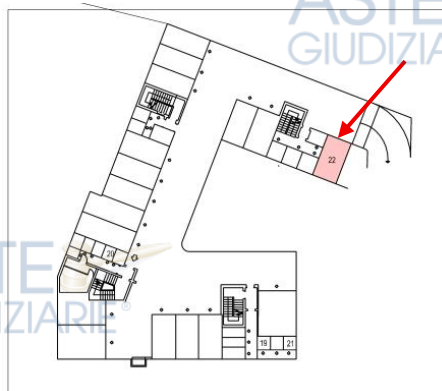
Individuazione della collocazione del subalterno 22 sulla planimetria del piano secondo del condominio
